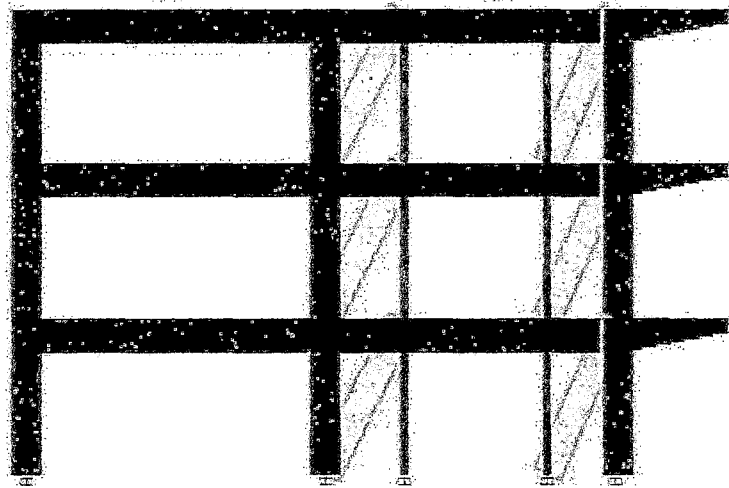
Modelización de mampostería, elevación lateral eje B-B
